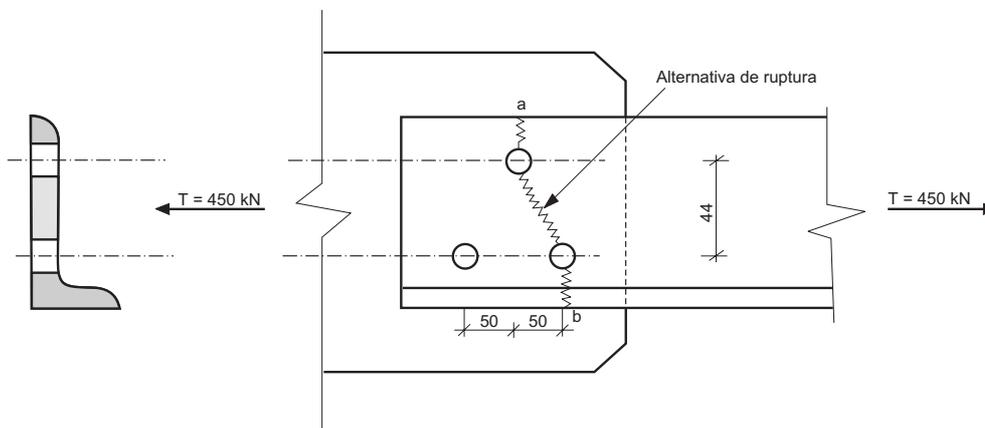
Esquema da cantoneira utilizada e suas conexões aparafusadas (cotas em mm)
